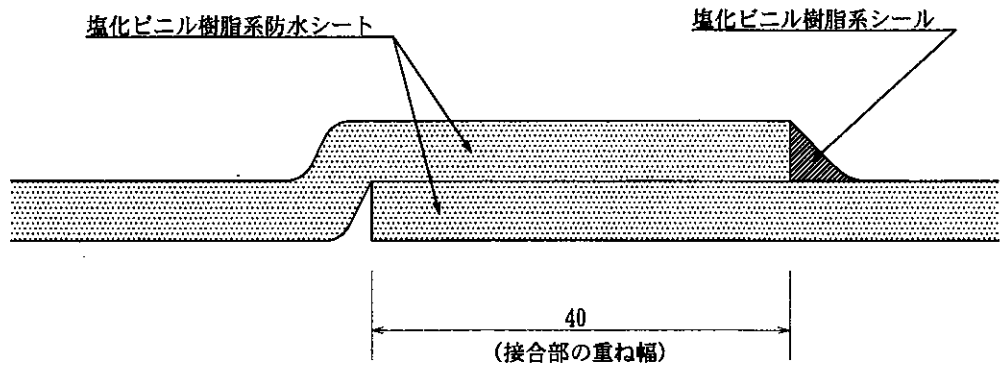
施工図 (塩化ビニル樹脂系防水シートの目地部断面)
